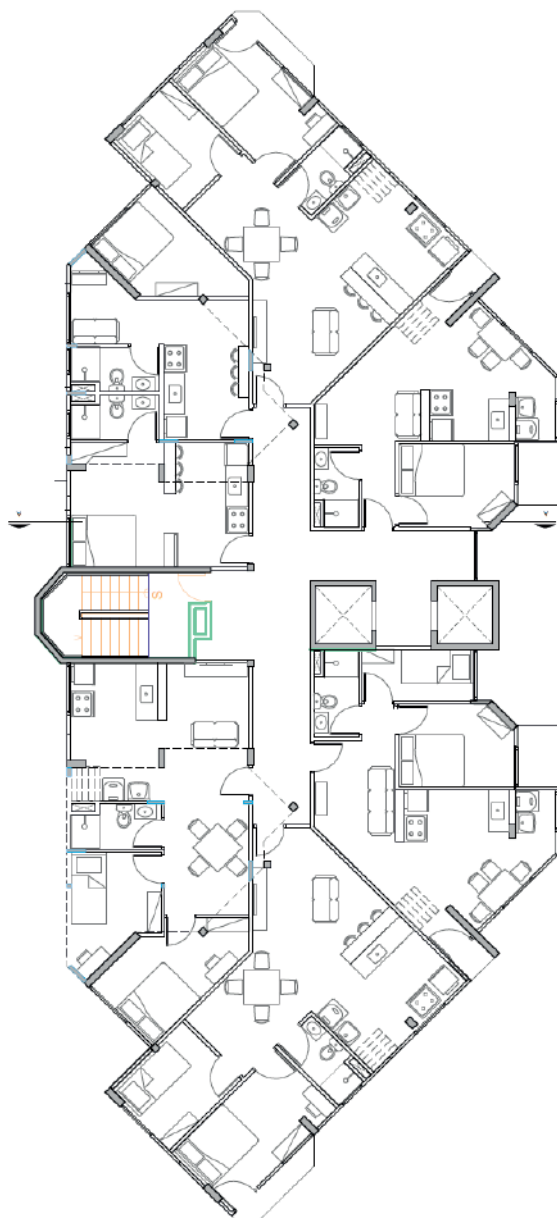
Projeto final da planta tipo dos pavimentos na edificação reabilitada. Acervo do Autor
